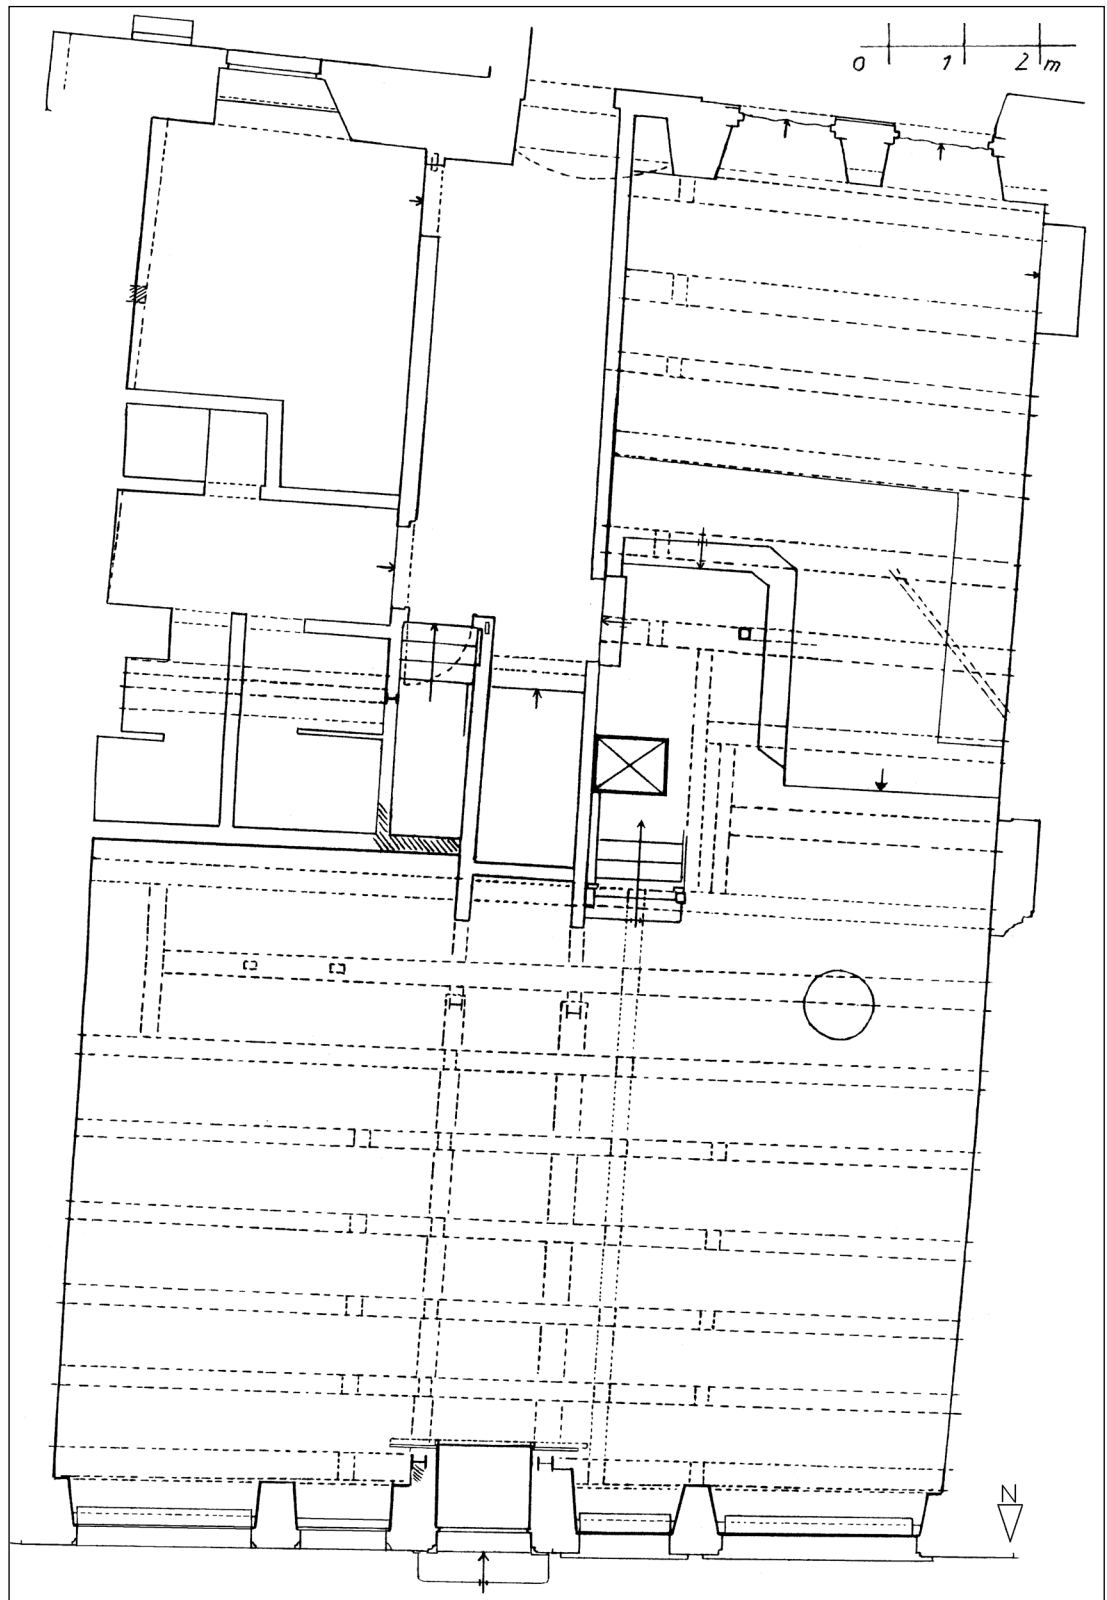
Hauptstraße 55, Grundriss Erdgeschoss.
